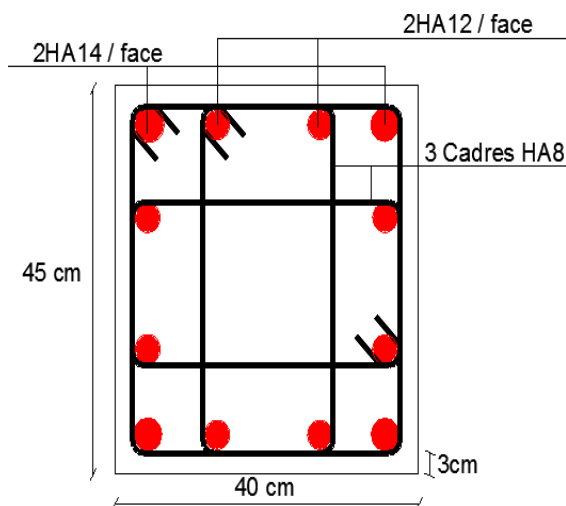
Schéma de ferrailage des poteaux d'Etages 3,4,5 et 6
